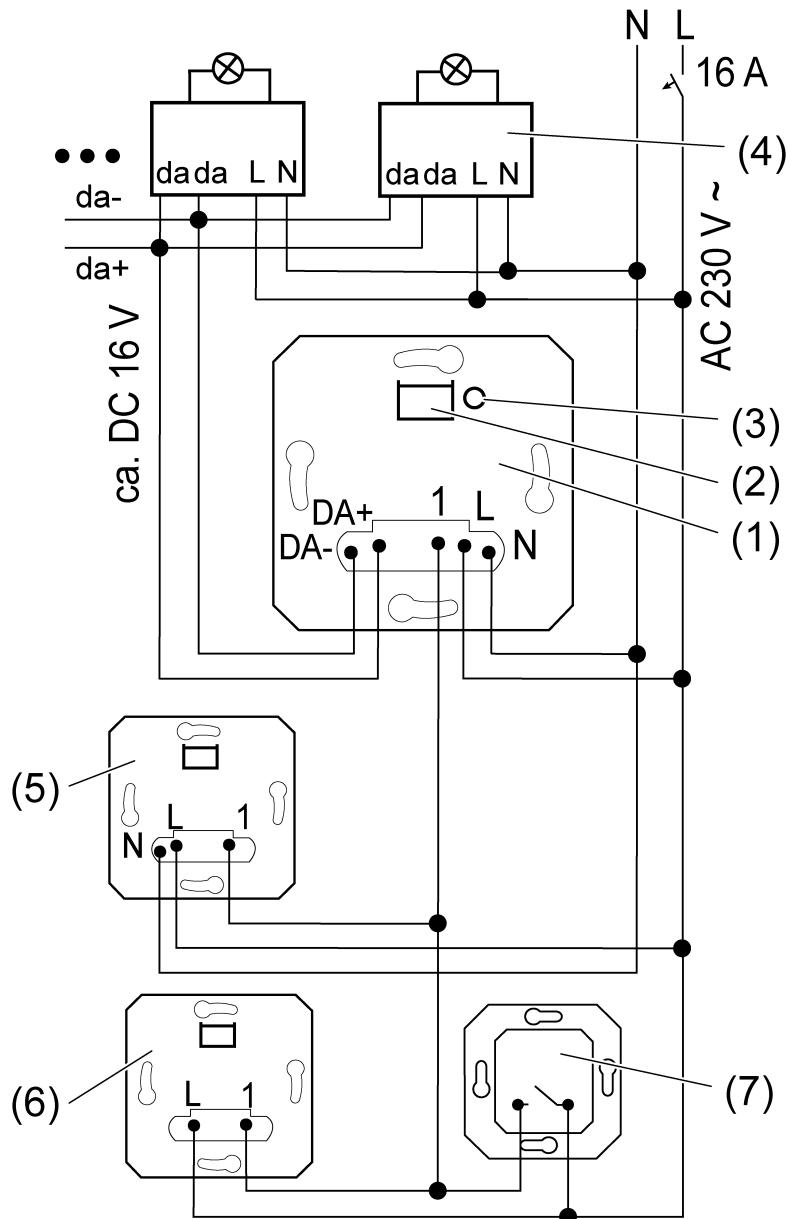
Plan de conexión con mecanismos auxiliares opcionales
